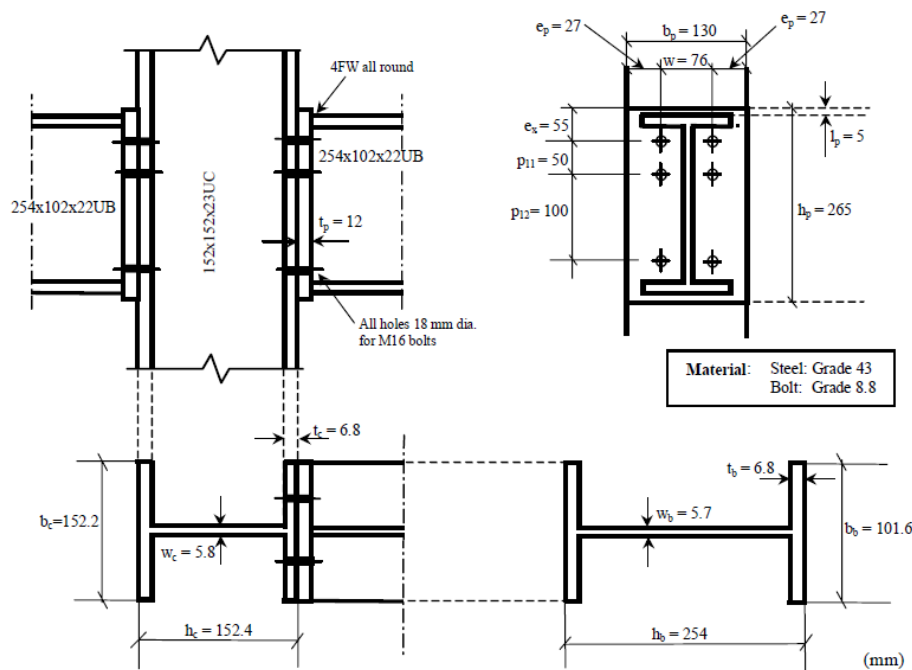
Características de uma ligação viga-pilar ensaiada. [79]
